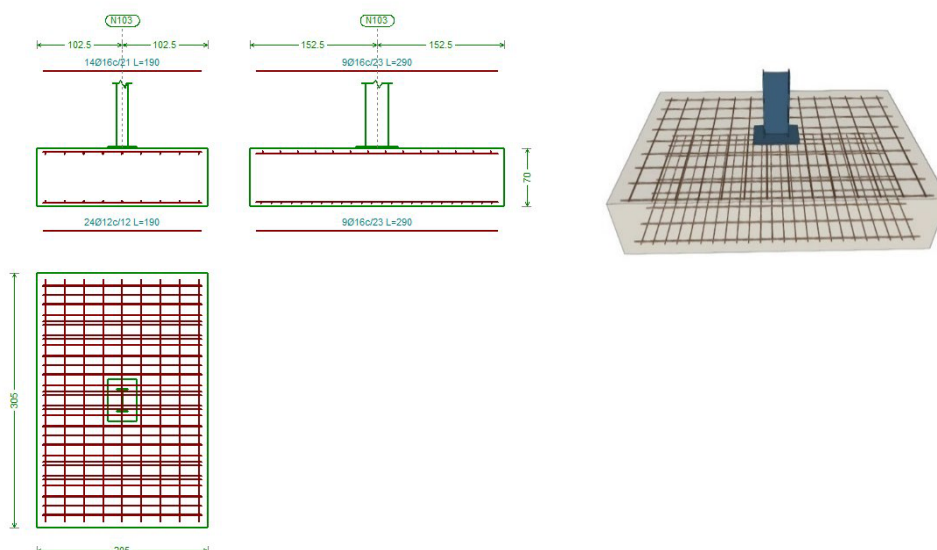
A. Aspecto zapatas rectangulares centradas tipo Z6, del pórtico de fachada. (CYPE 3D)
